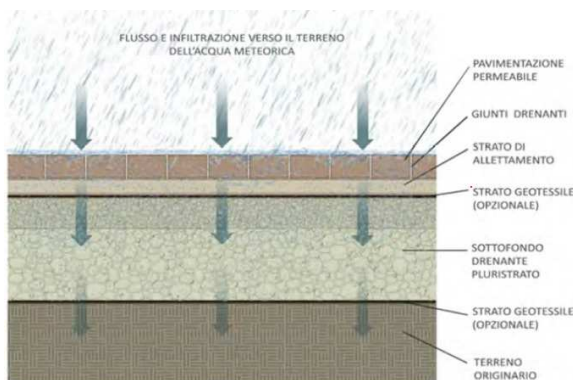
Pavimentazioni permeabili. Fonte: Linee guida SUDS Bologna
